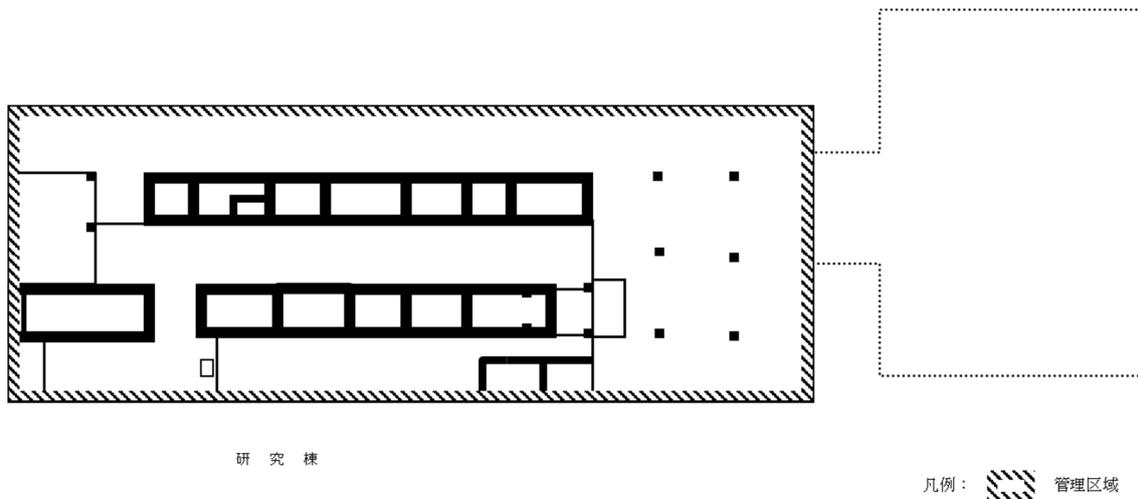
4 高レベル放射性物質研究施設 地階平面図
